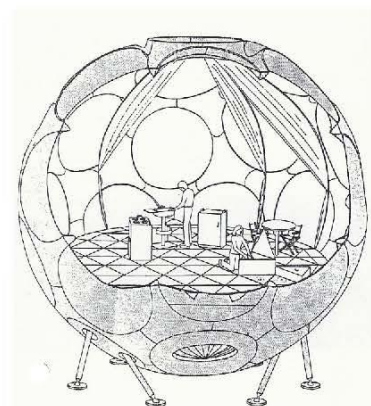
Dibujos Fly's Eye, por Fuller Snyder, A. cortesía del Instituto Buckminster Fuller. 1981.
